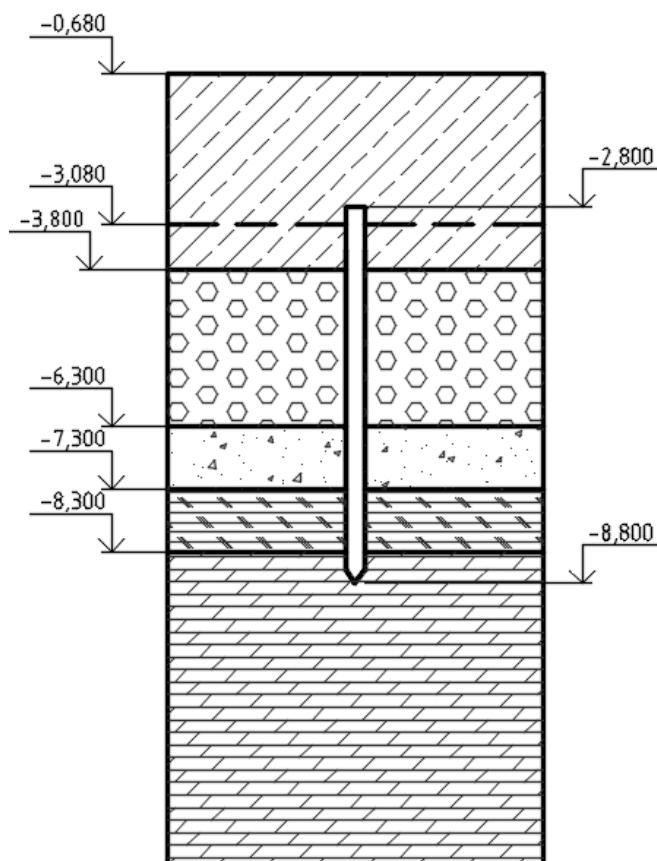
Схема расположение забивной сваи в грунте
